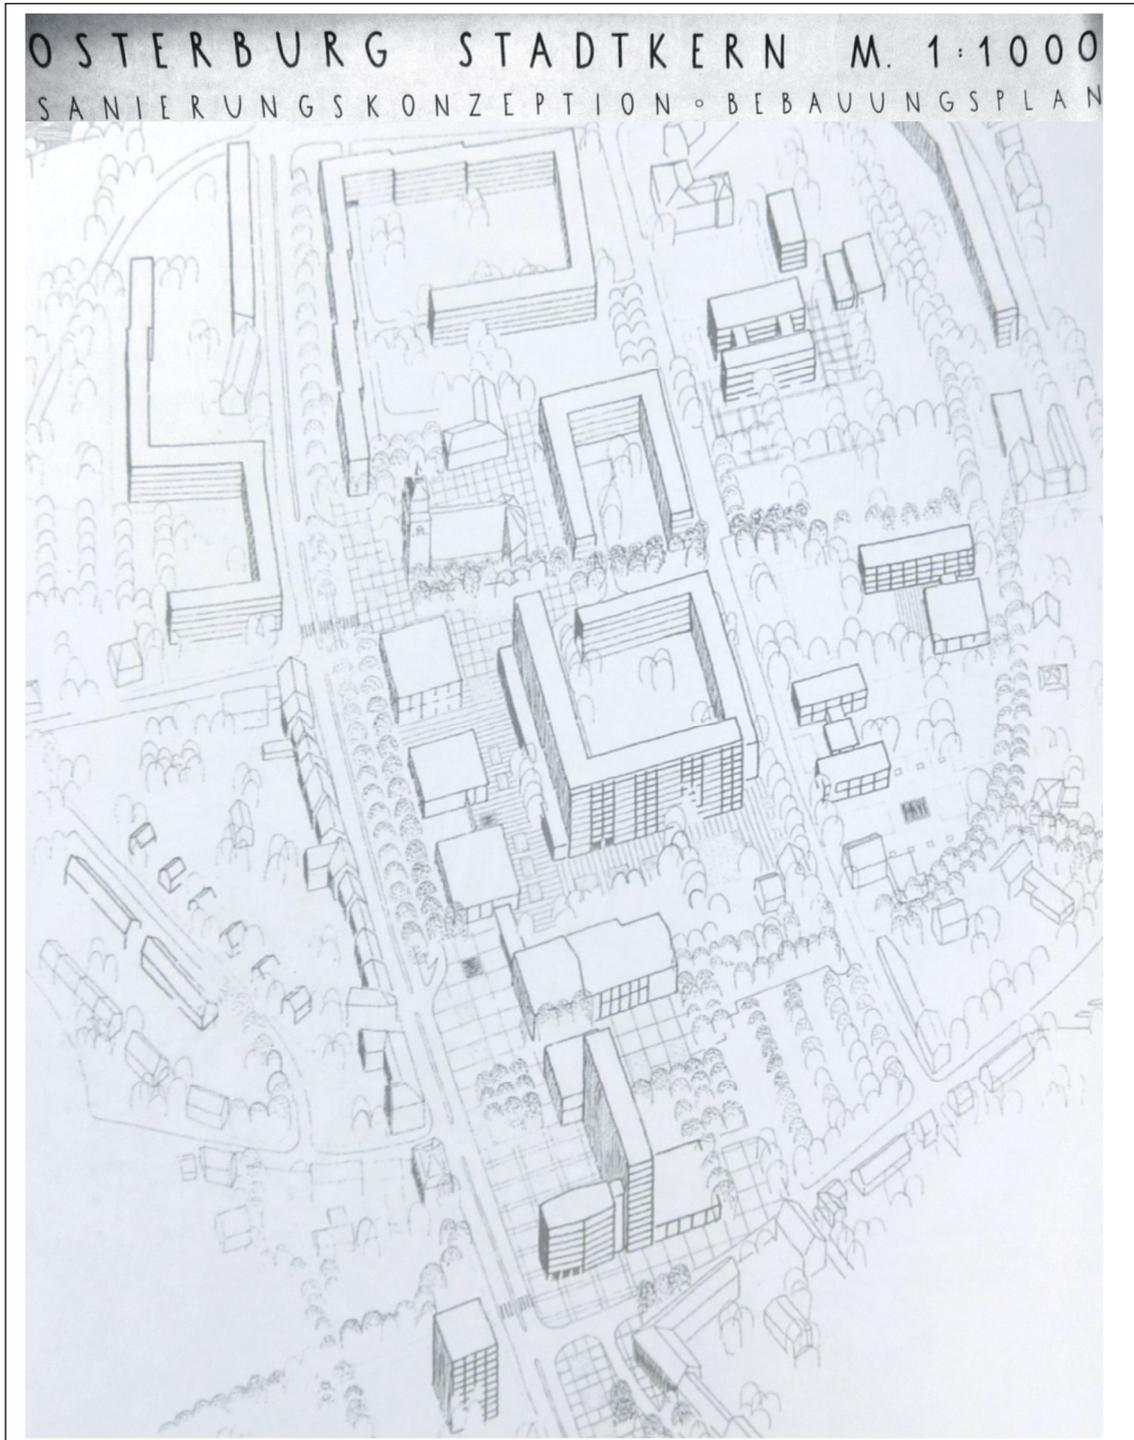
Sanierungskonzeption Osterburg Stadtkern, Büro f. Städtebau u. Architektur Magdeburg, 1969.
